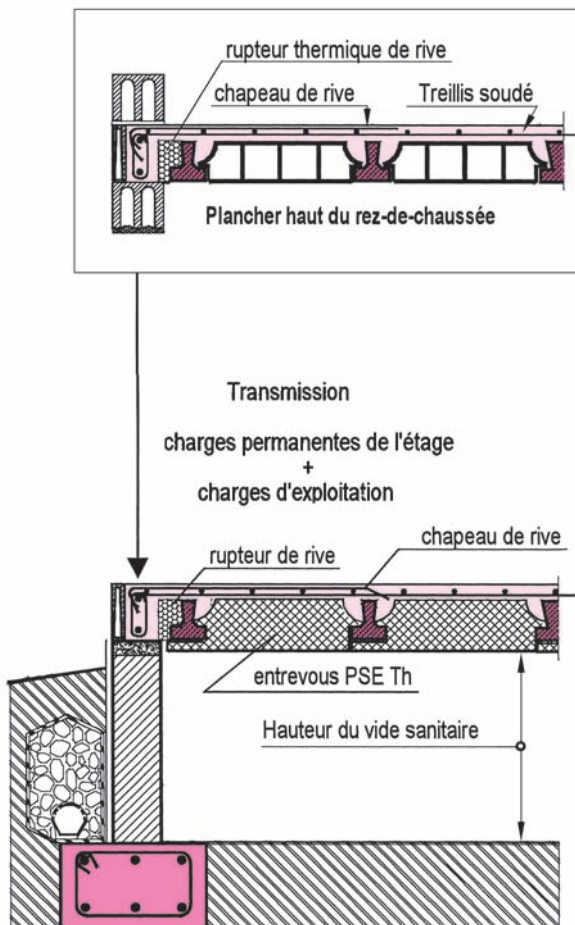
Plancher sur vide sanitaire et entrevous PSE à languette
